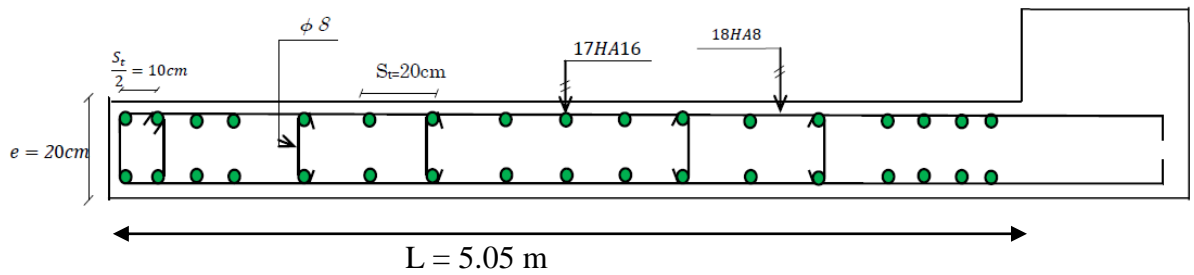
Ferrailage du voile Vx1 au niveau du RDC.
